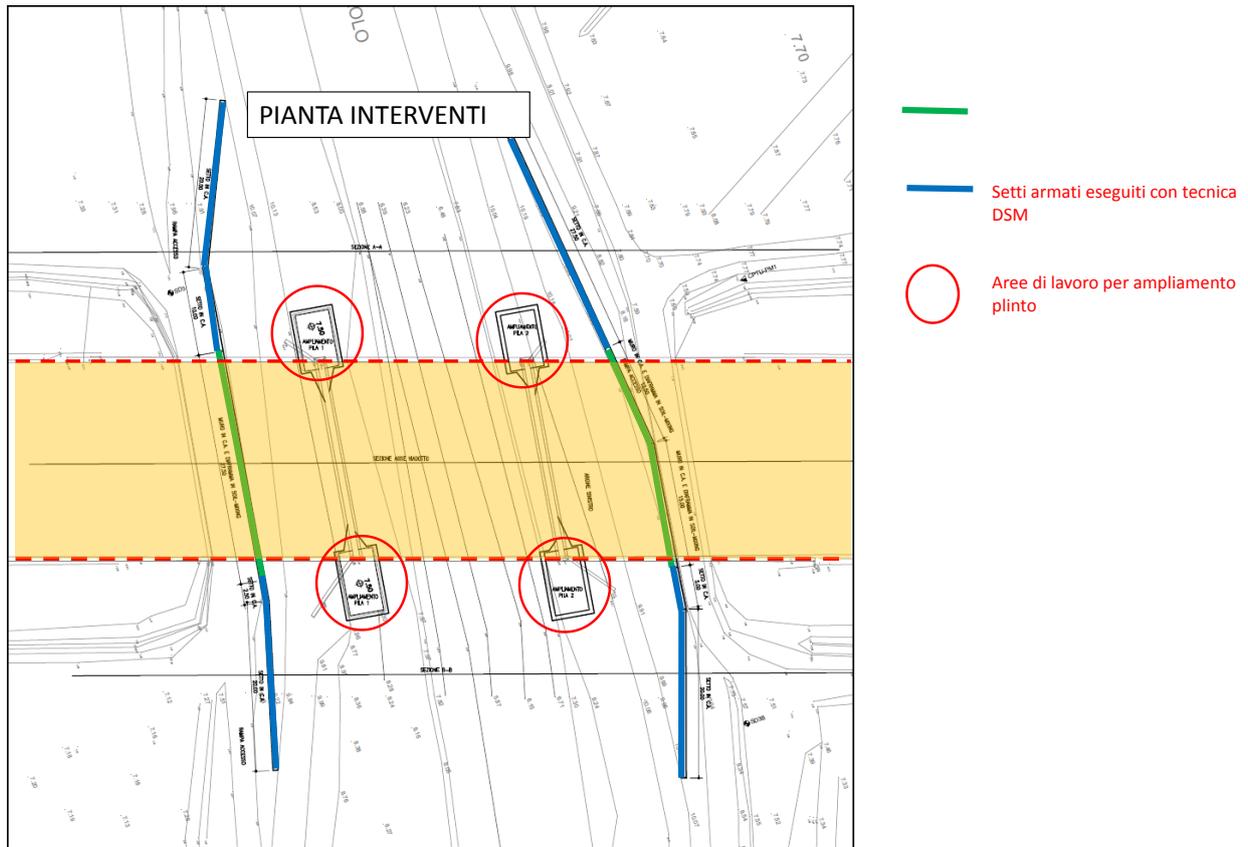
Ponte Canale Bagnarolo – Pianta interventi
